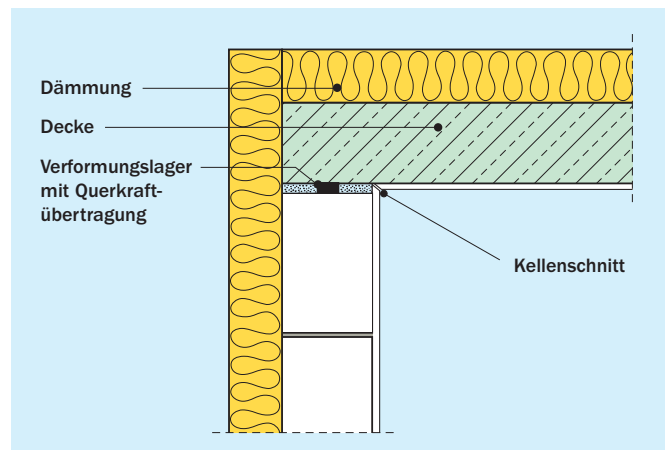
Konstruktive Maßnahmen zur Zentrierung der Deckenauf-lagerkraft am Beispiel der Außenwand unter einer Dach-decke – Verformungslager mit Zentrierstreifen zwischen Wand und Decke
